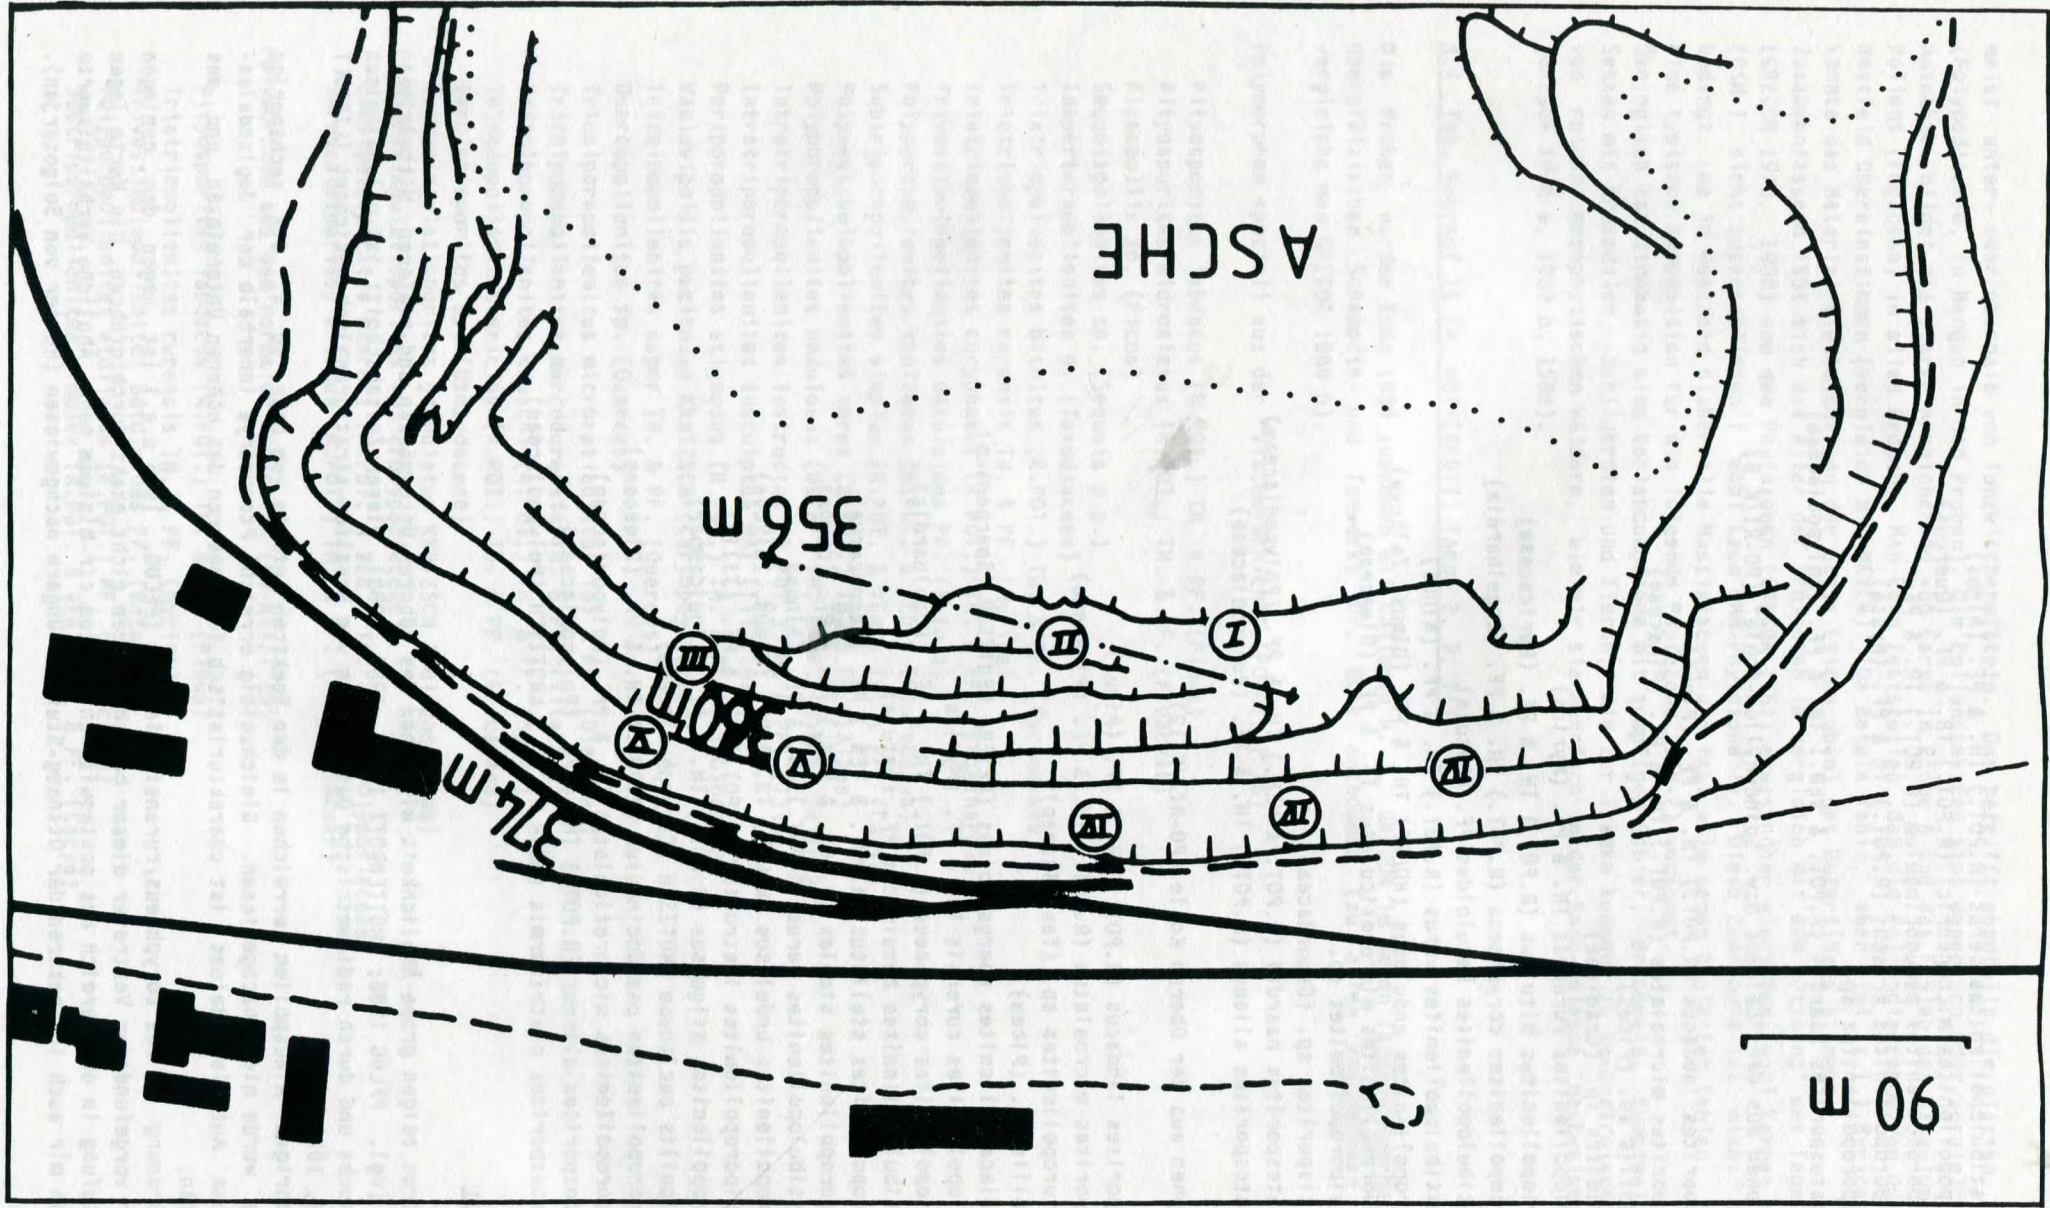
Lageplan des Lagedeues westlich (nach Planen der BDI 1977) mit Gipsanlagern, Werkstätten
